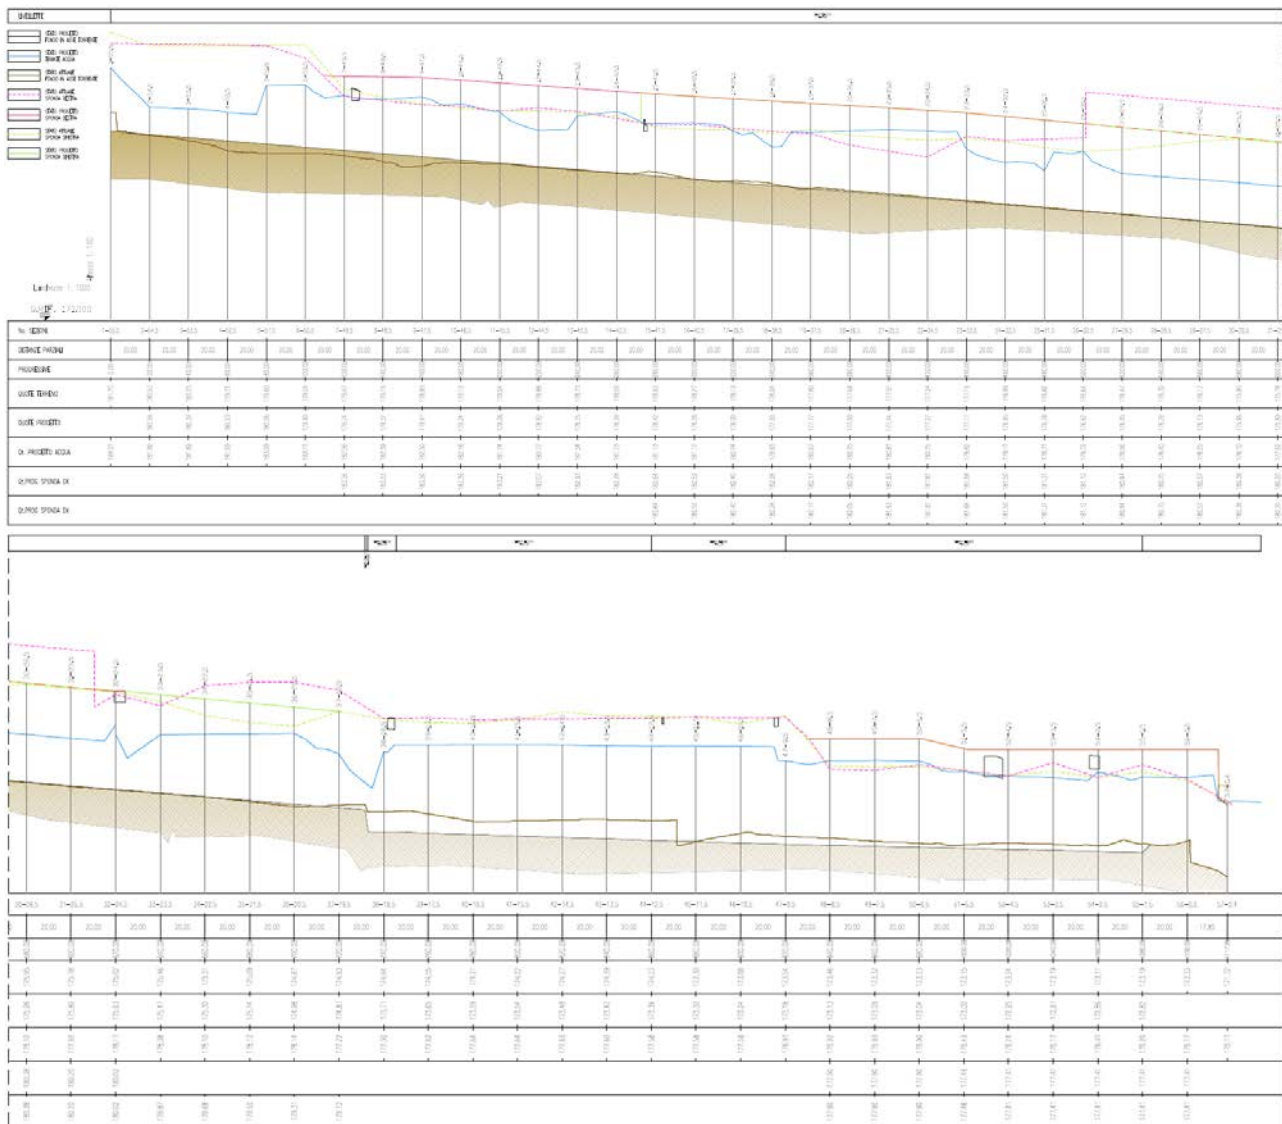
Estratto Tavola 05. Stato di progetto, profilo.
